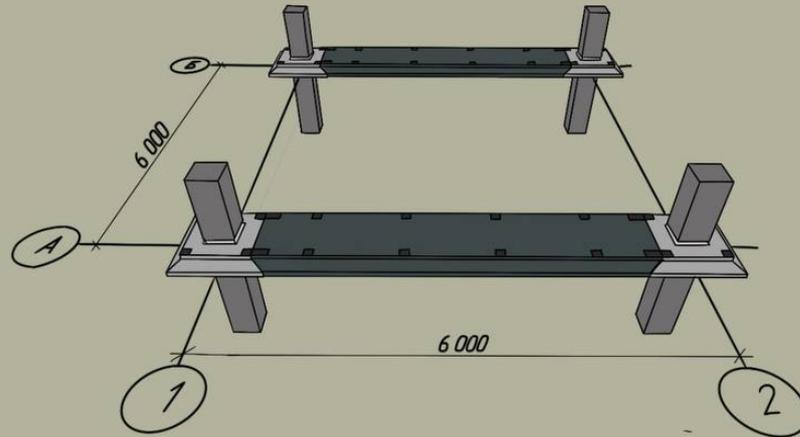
Схема монтажу міжколонних плит
